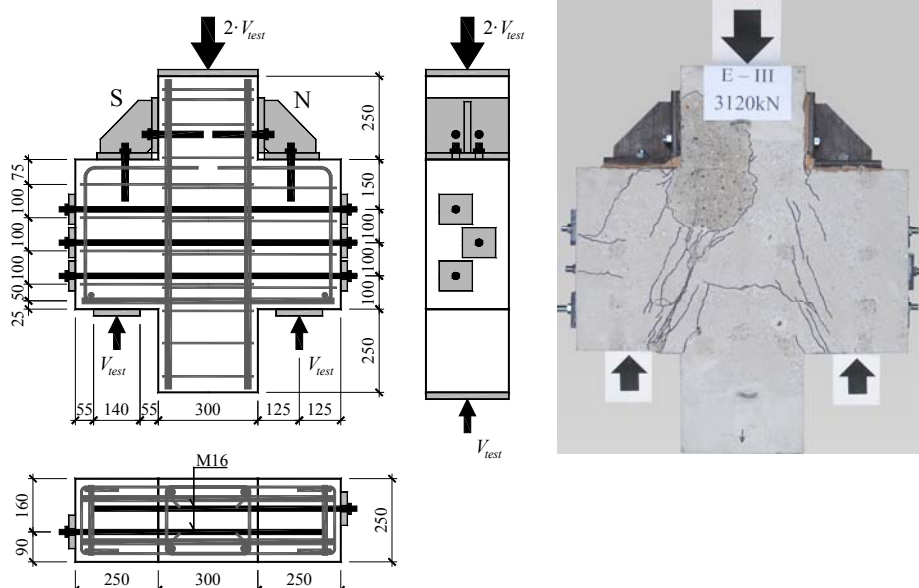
Konstrukcja elementu D-III (szczegóły patrz załącznik) i widok po zniszczeniu
